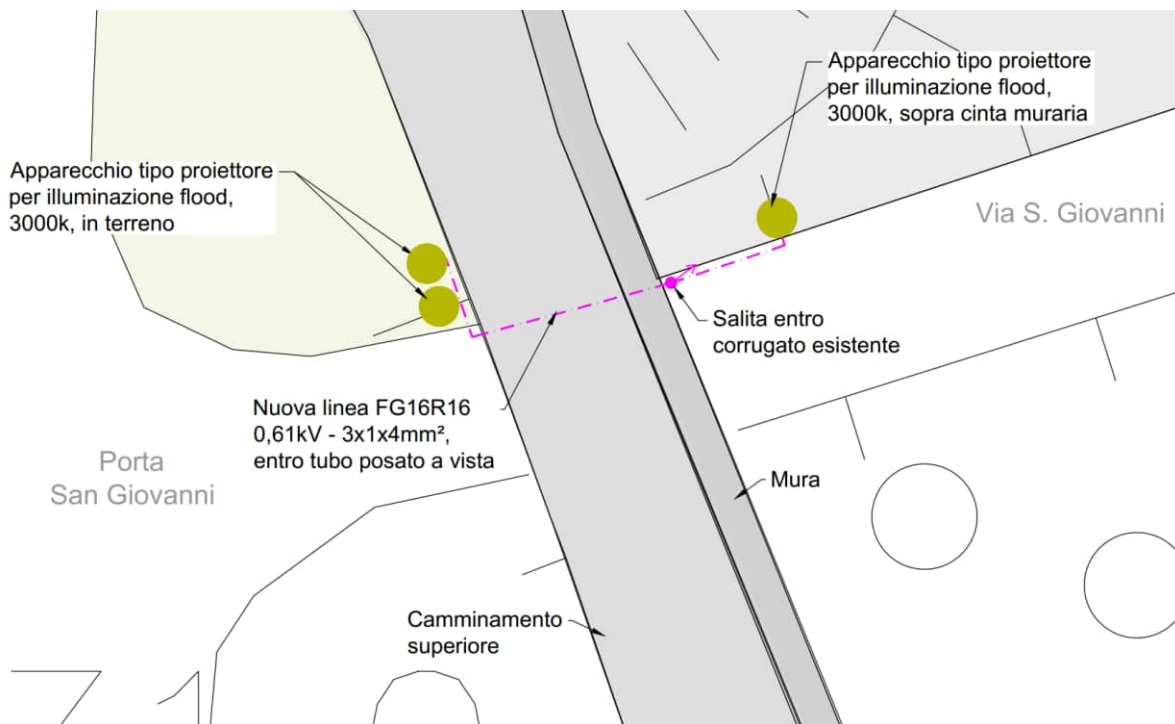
Planimetria di progetto illuminazione Porta San Giovanni
